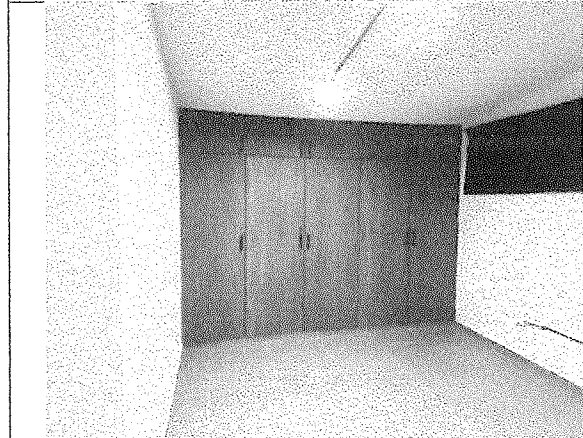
ESTACION SANTA ROSA (Mantenimiento y adecuación de alojamientos)
